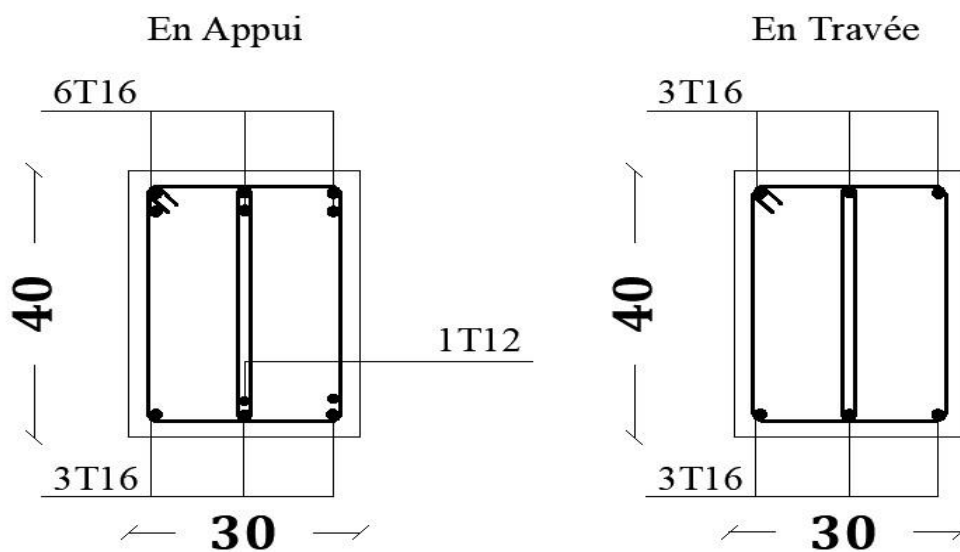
Schéma de ferrailage de la poutre secondaire 30x40
